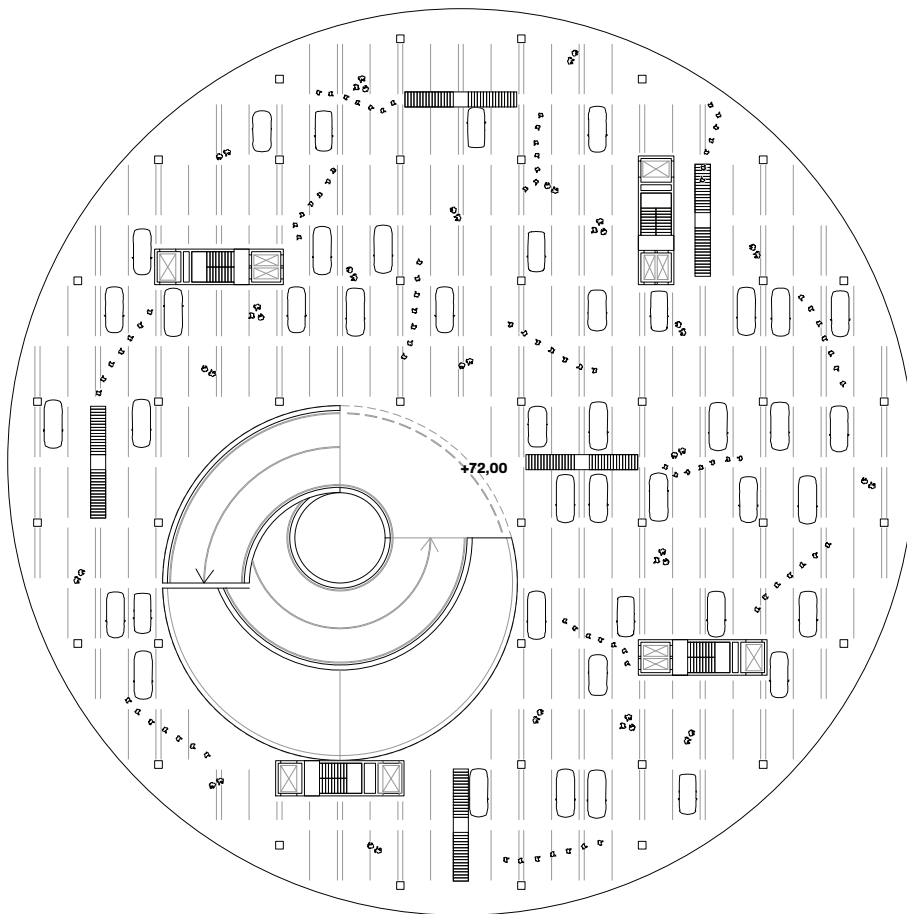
Grundriss . Obergeschoss (+66) . 1:750
